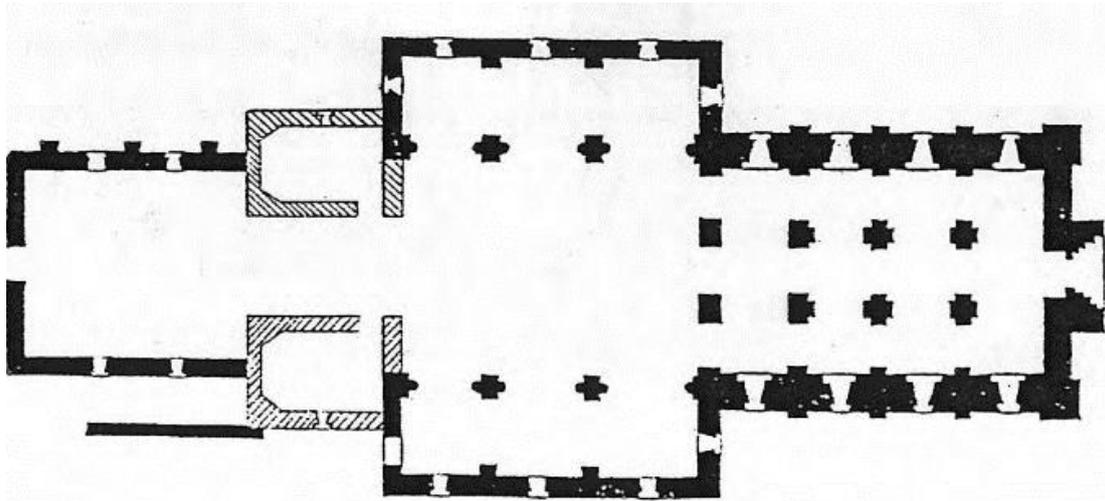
Proposta de reconstituição da planta da Igreja de Santa Cruz de Coimbra. 1971. Manuel Real
